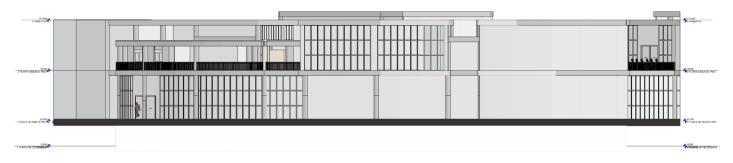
Fachada vial anillo vial verganzo Fuente: Elaboración propia
